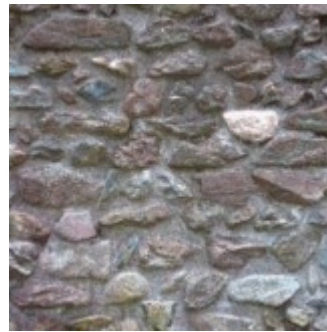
Campione murario in pietra. Foto di S. Roberto.
